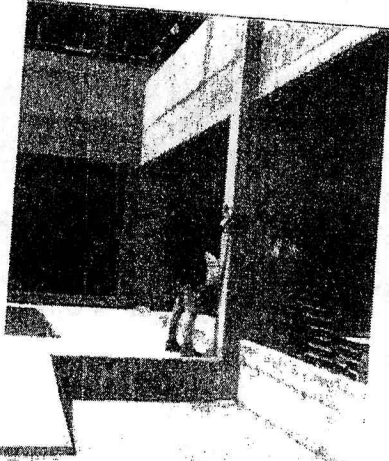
Colocación de sello de suspensión en el acceso frontal de la edificación.
